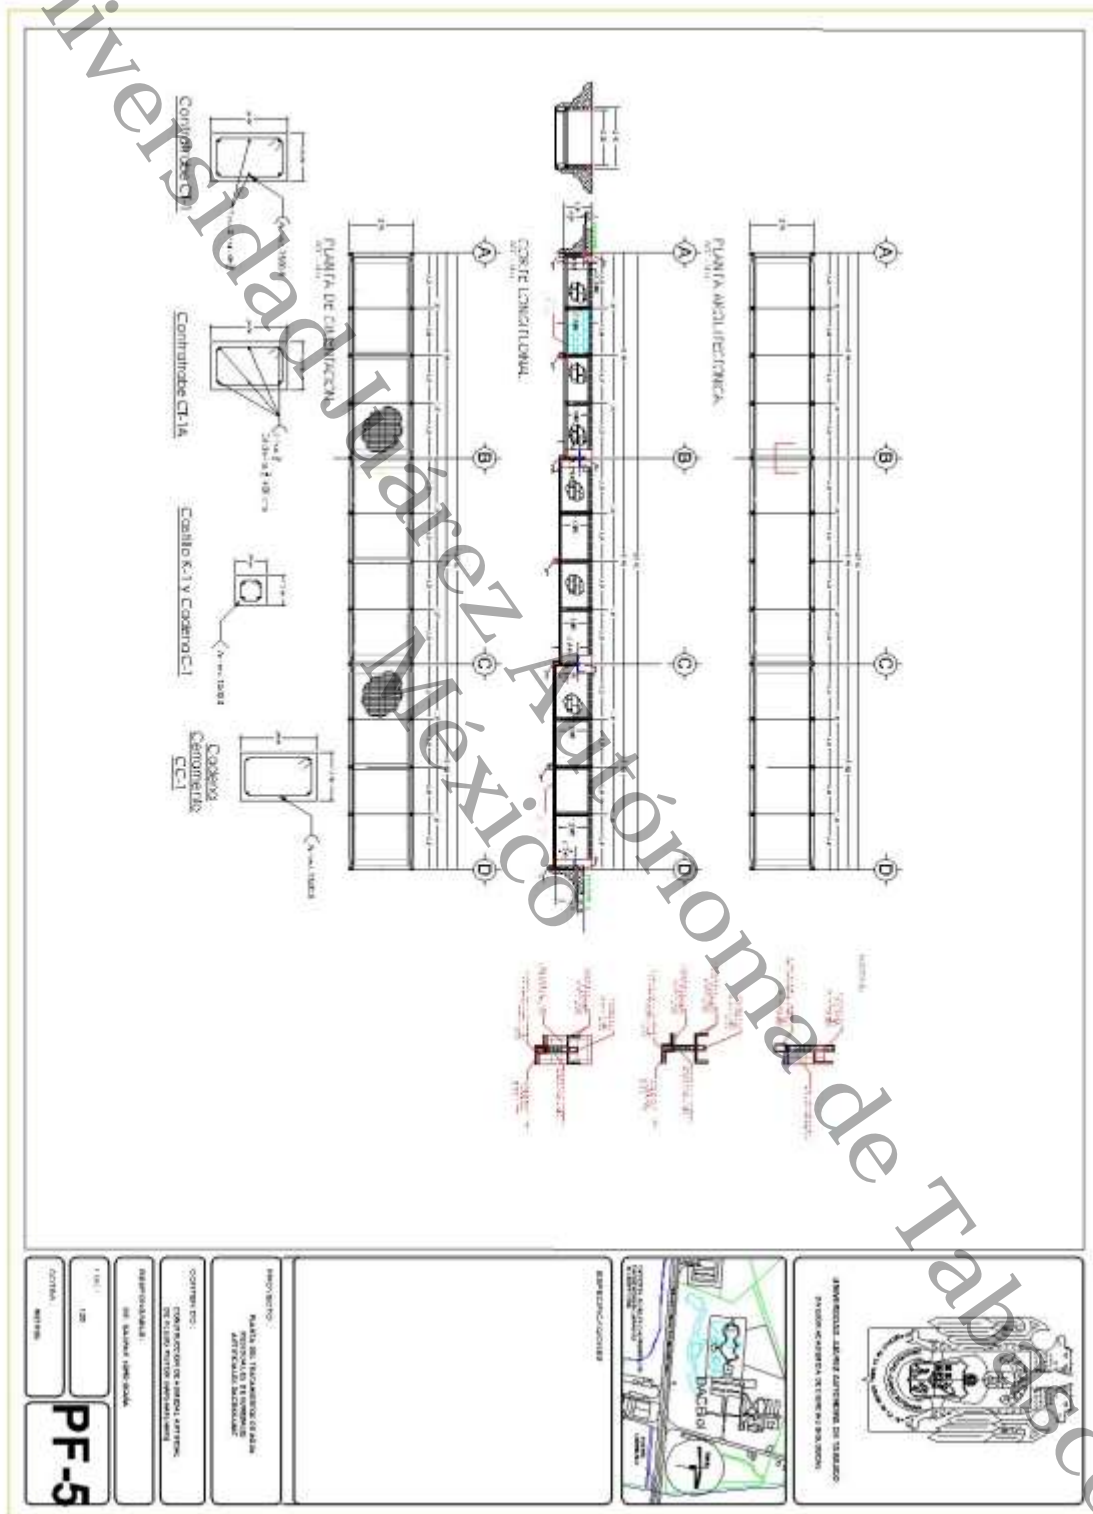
Humedal Artificial Detalle Constructivo. Fuente: Gaspar López 2018.
